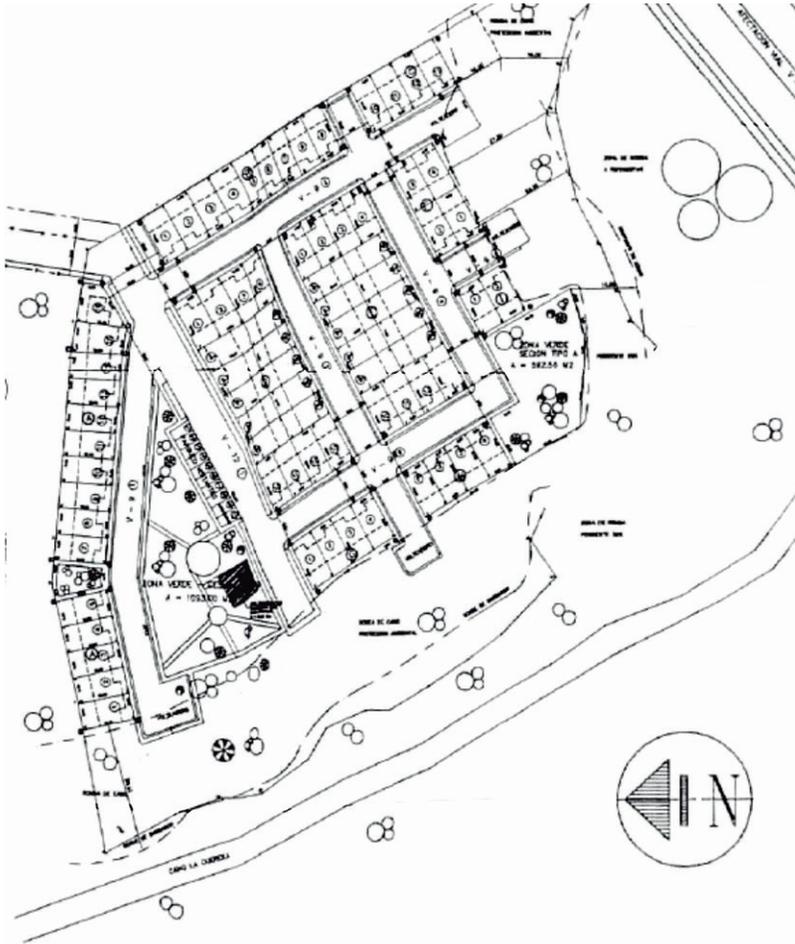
/ Planimetría de proyecto urbanístico (Década de 1970)
